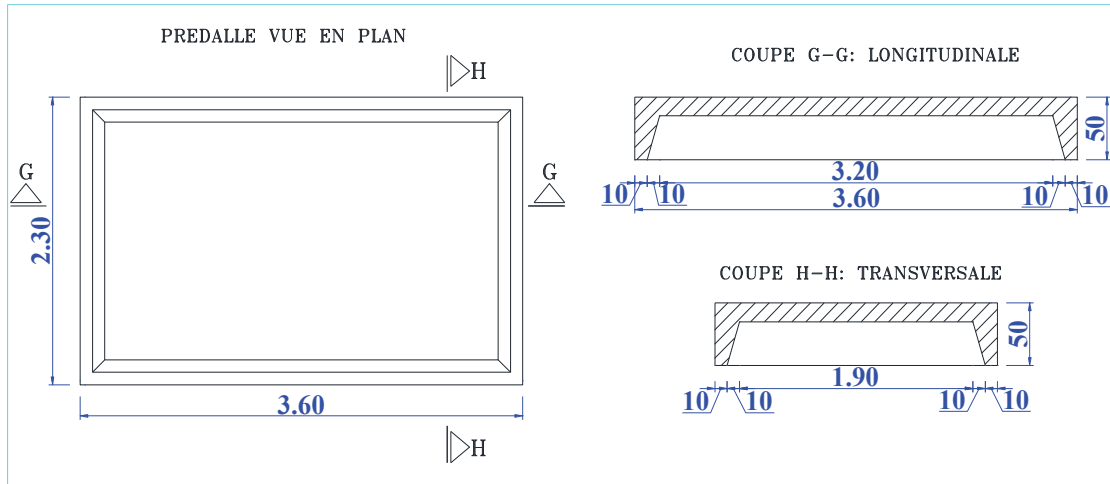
Vue en plan, coupe transversale & longitudinale de la prédalle
